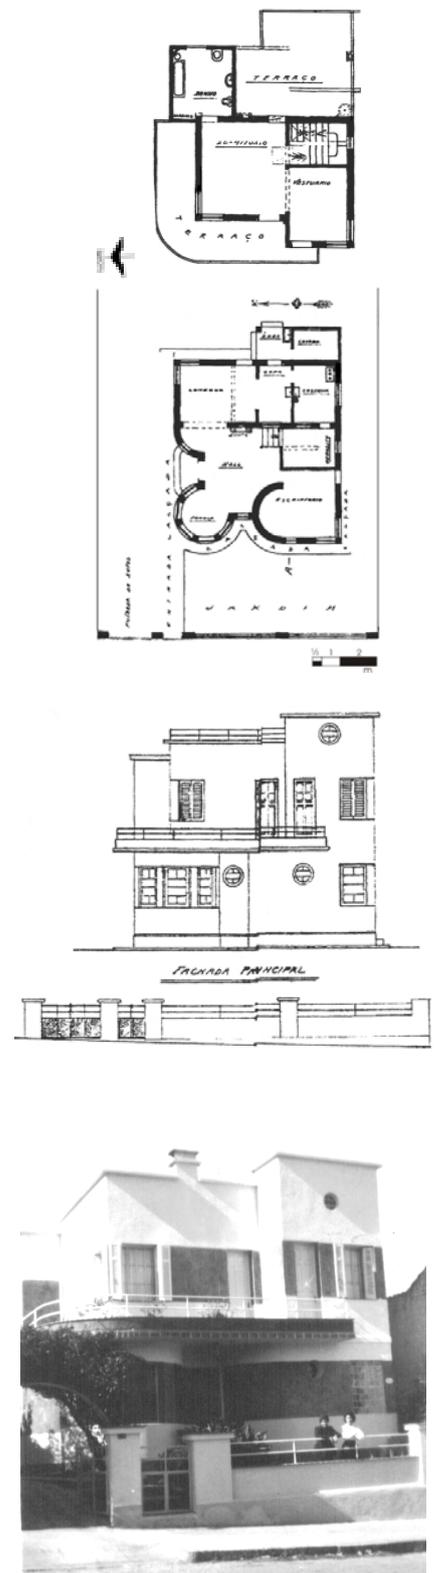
Casa Jerônimo Mércio da Silveira (1936), de Henrique Tobal. Plantas baixas pavimento térreo, superior e Fachada. Fonte: Maria Luiza Teixeira da Luz.
